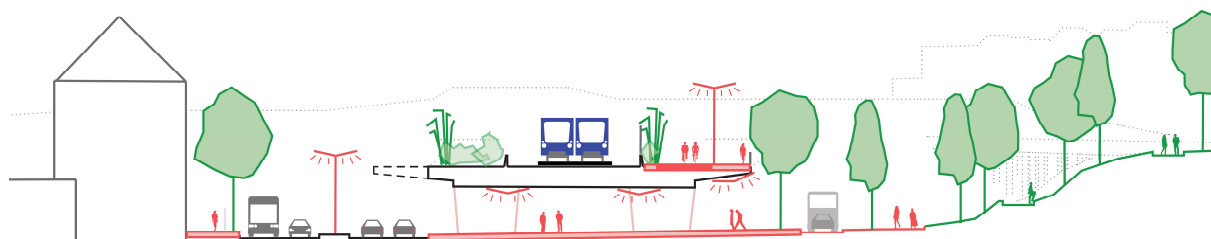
Coupe à travers le viaduc à hauteur de la chaussée de Watermael (ORG, 2018)
